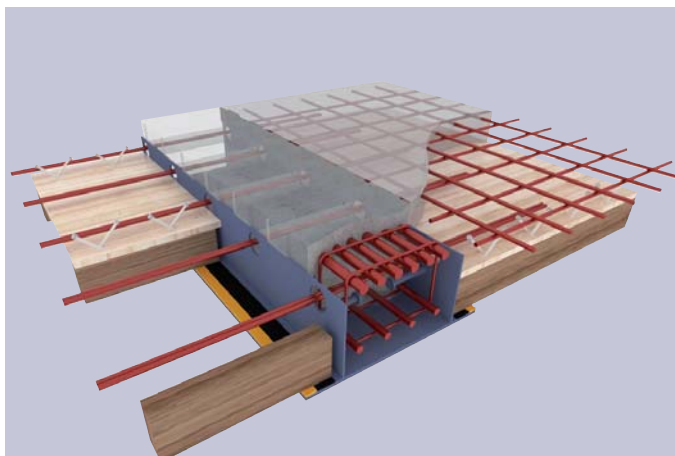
Planșeu din beton armat și grinzi de lemn, sprijinit pe grinzi PFEIFER-Hybridbeam®
